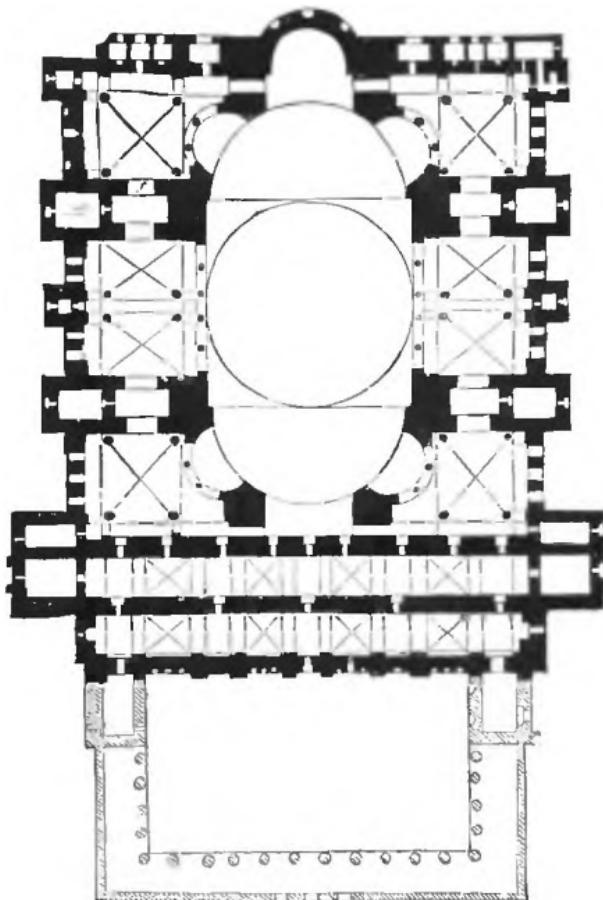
Konstantinopel, Grundriss der Sophienthürche.
